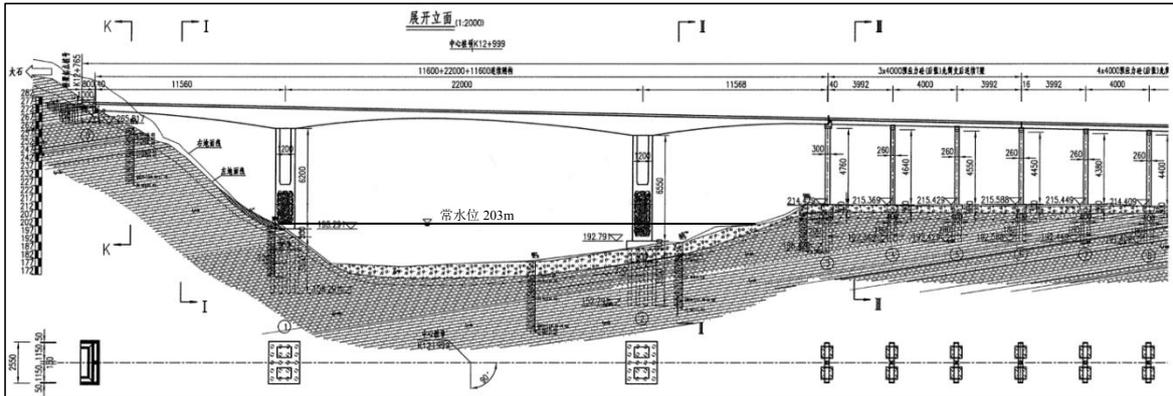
涪江五桥桥型剖面布置图（局部图）
